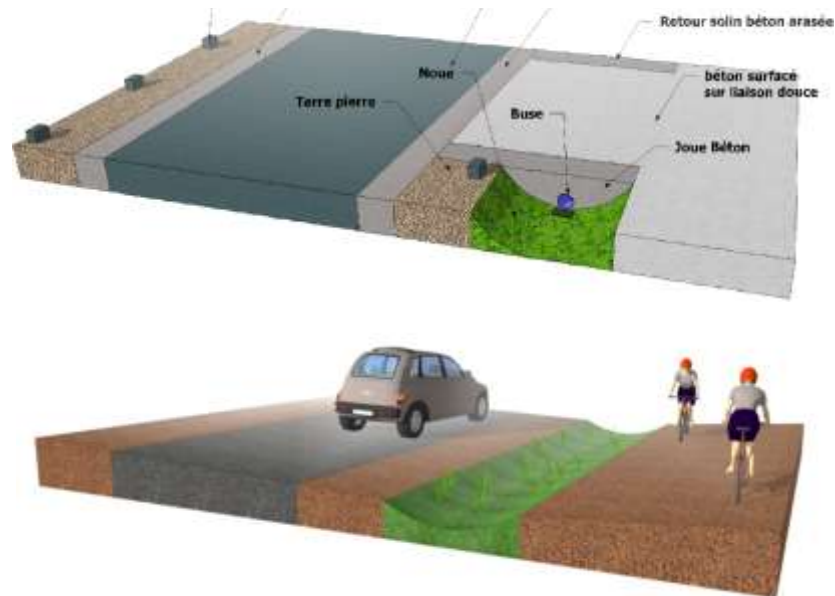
EXEMPLES DE VOIE SECONDAIRE AVEC NOUE DE COLLECTE AU DROIT D'UN ACCES
